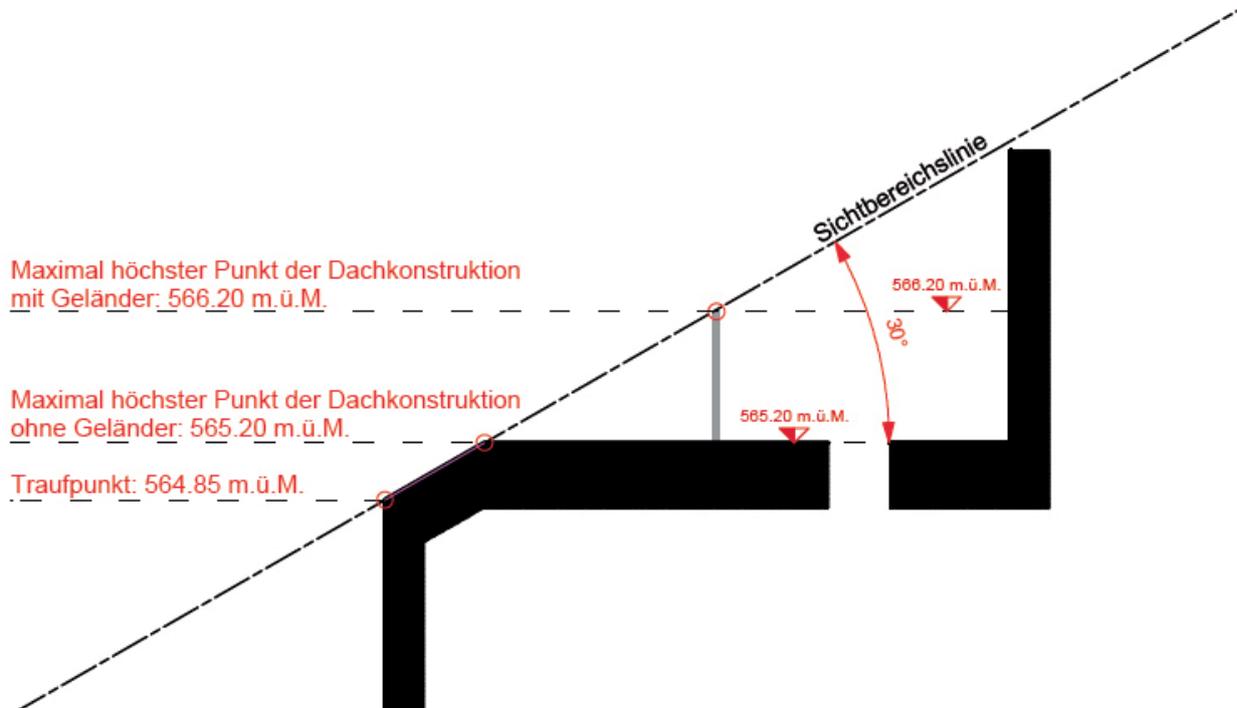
, Detail zu Art. 3, Höhe der Gebäude
